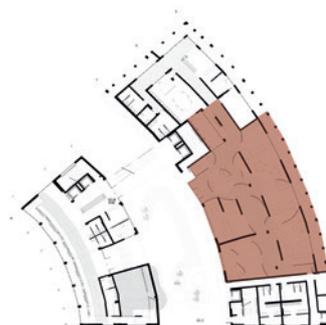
Planta Piso 0 | Localização das Salas de Lazer | Volume B
